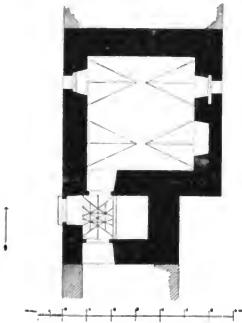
Březnitz. Grundriss zweier gewölbten Räume in der Feste.
